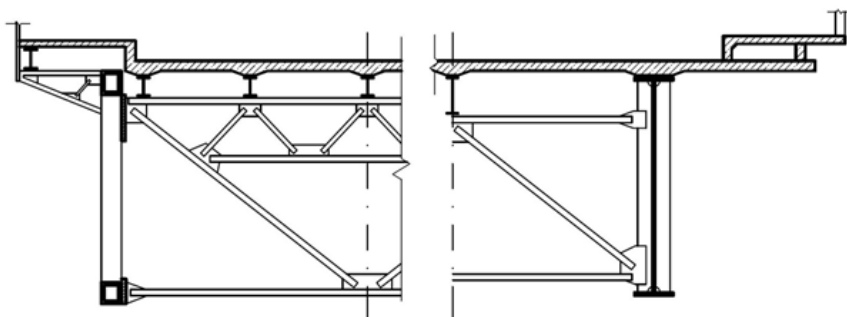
Поперечные разрезы пролётных строений мостов
